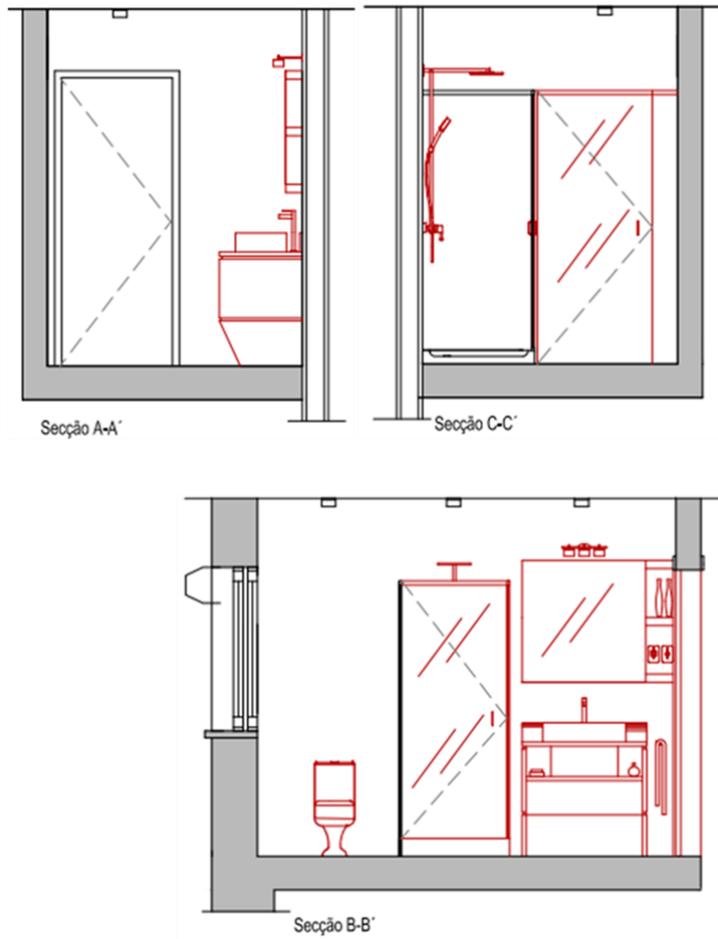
A. 4 - Desenho esquemático do interior da instalação sanitária do piso 0 (Fonte: de autor).
